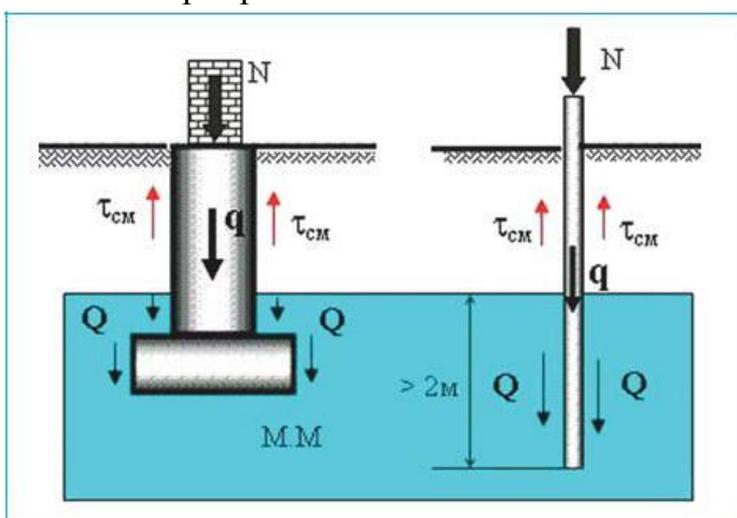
Расчетная схема устойчивости отдельно стоящих свайных фундаментов в вечномерзлом слое грунта
